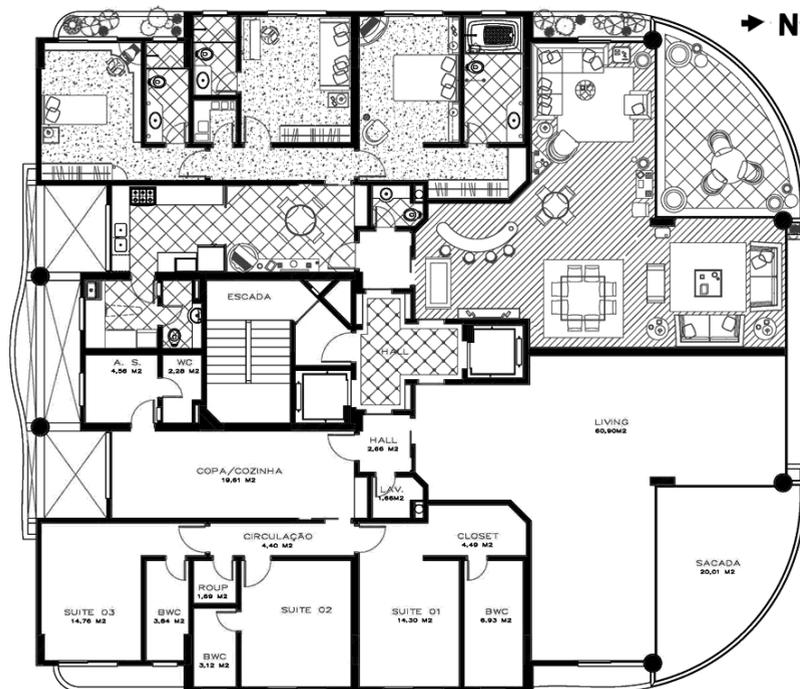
Planta baixa tipo padrão do pavimento tipo
